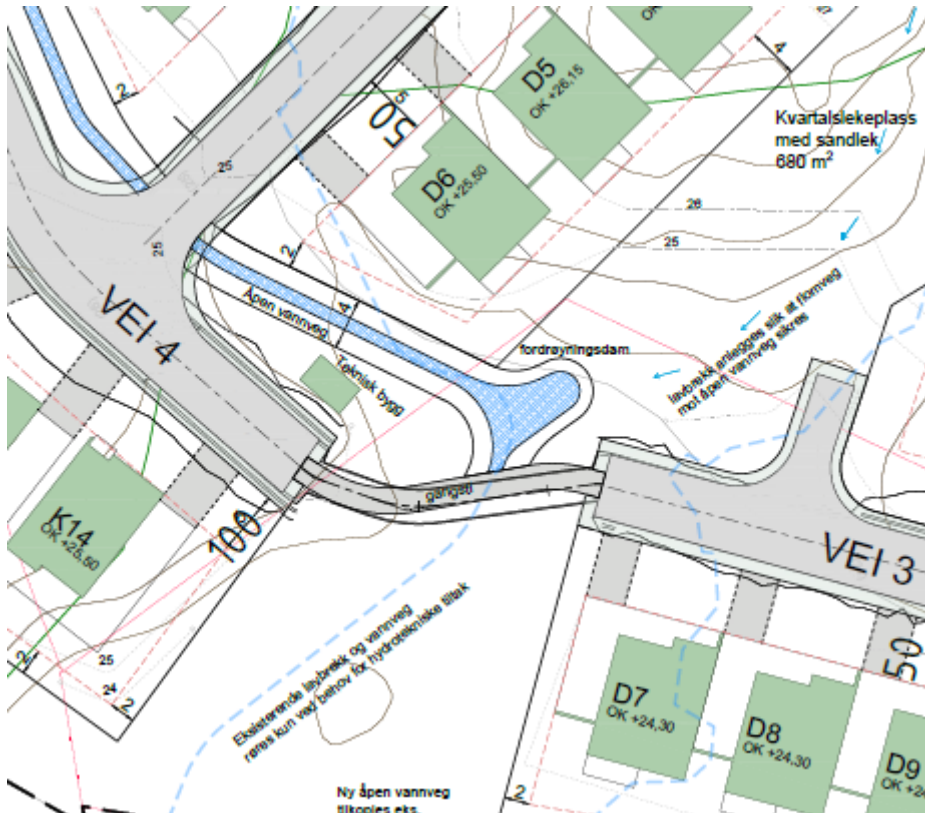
Plassering av gropmagasinering sentralt i planen.
